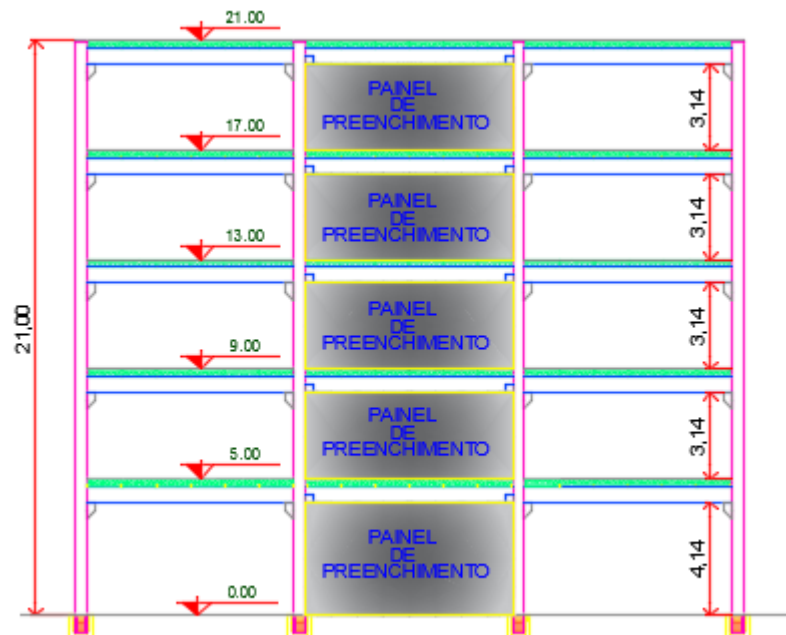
Corte AA da estrutura contraventada através de painéis de preenchimento
